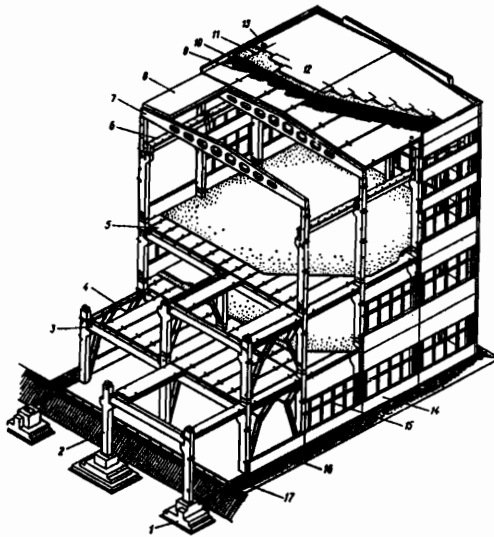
Основные элементы многоэтажного здания со сборным железобетонным каркасом: 1 – фундамент; 2 – колонна; 3 – ригель междуэтажного перекрытия; 4 – вертикальные связи между колоннами; 5 – плита междуэтажного перекрытия; 6 – подкрановая балка; 7 – балка покрытия; 8 – плита покрытия; 9 – пароизоляция; 10 – утеплитель; 11 – выравнивающий слой; 12 – кровельный ковер; 13 – воронка внутреннего водостока; 14 – стеновая панель; 15 – оконная панель; 16 – отмостка; 17 – фундаментная балка
